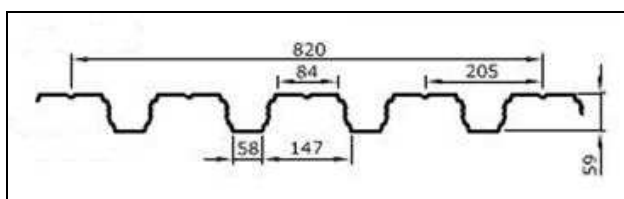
Geometría de la chapa perfilada trapezoidal de acero galvanizado.
